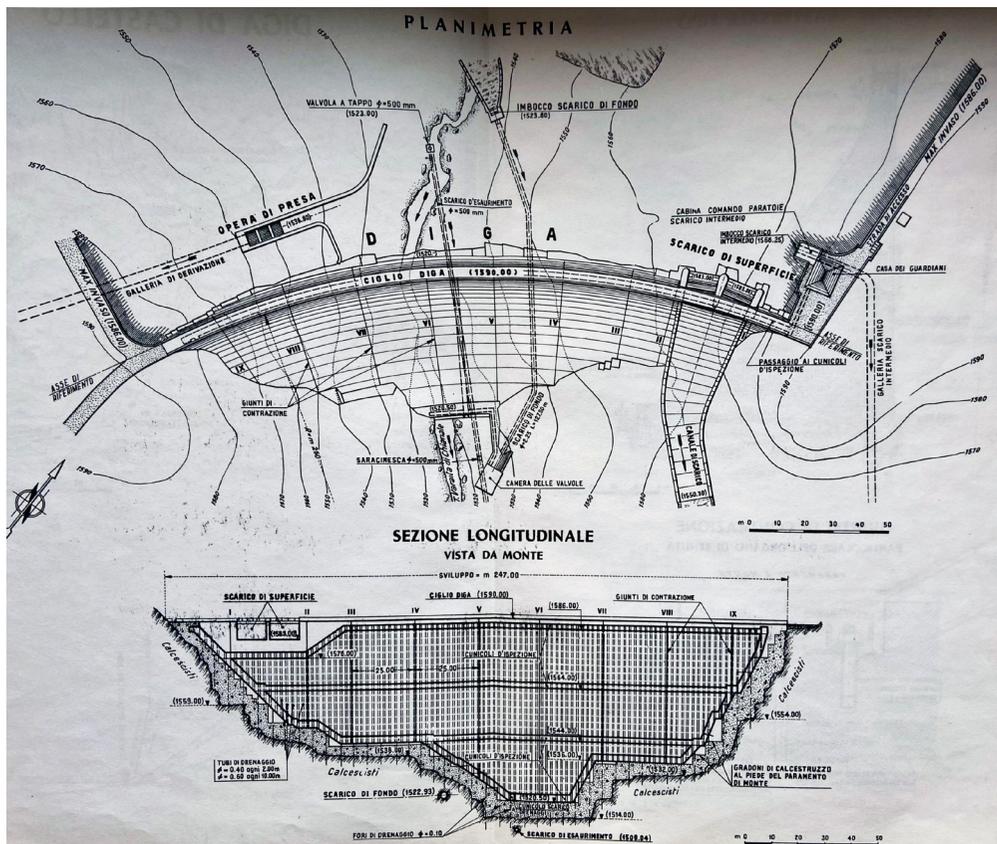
\_ Planimetria e Sezione Longitudinale Diga di Castello, in Anidel, cit., p. 164.
